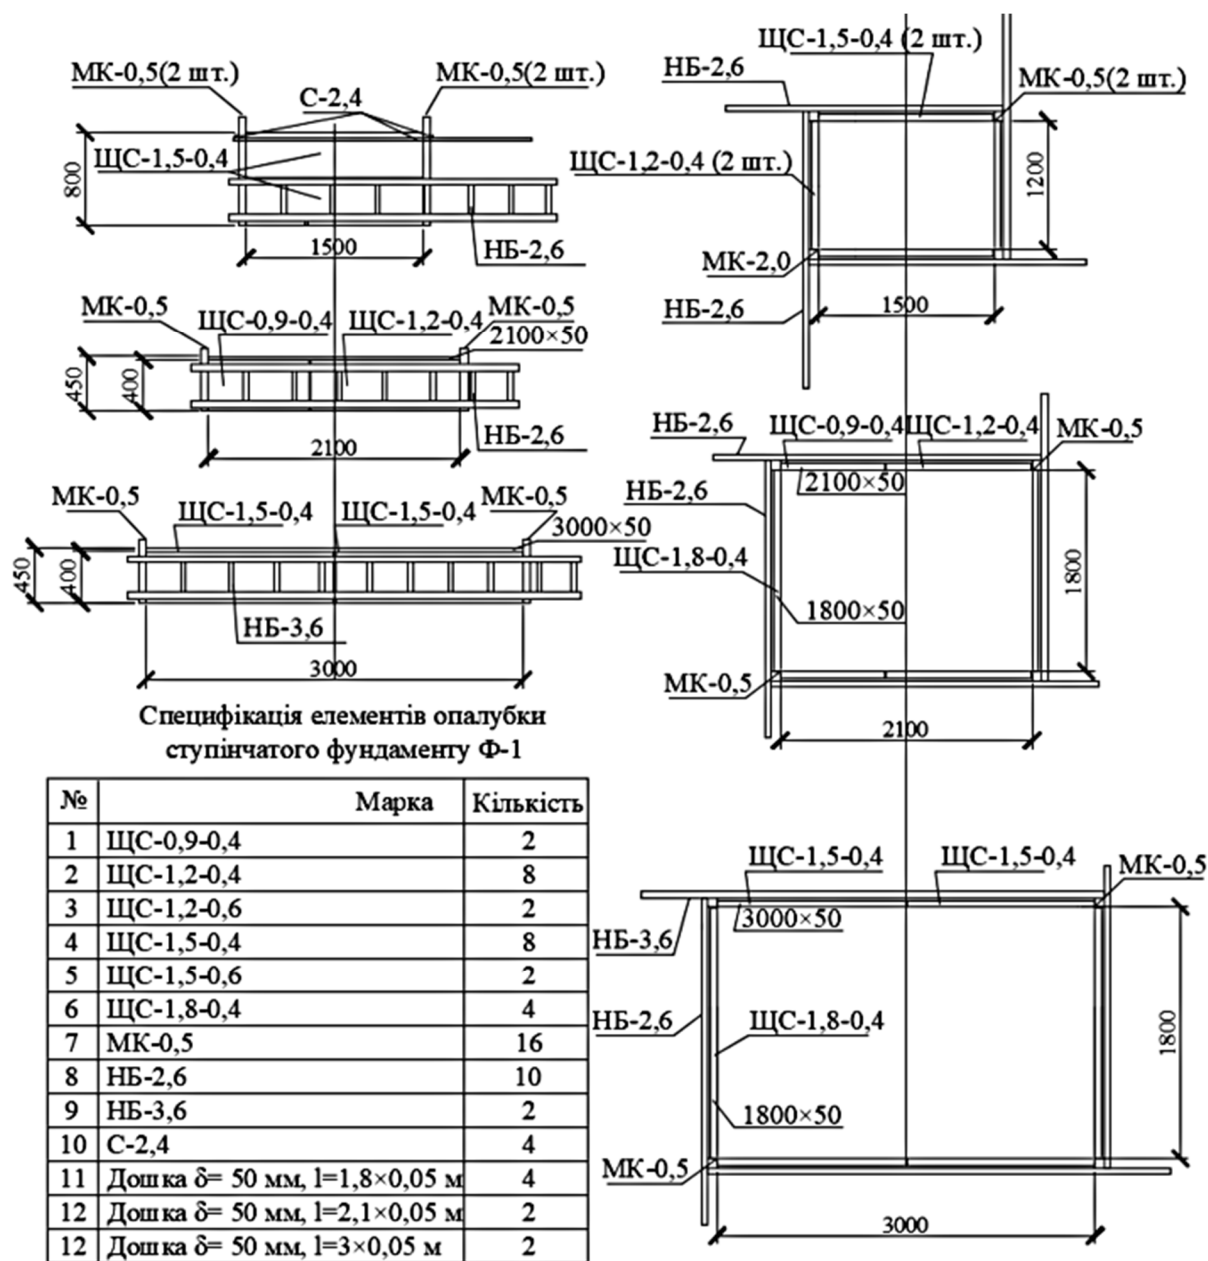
Конструктивна схема ступінчастого фундаменту та перелік опалубних елементів
